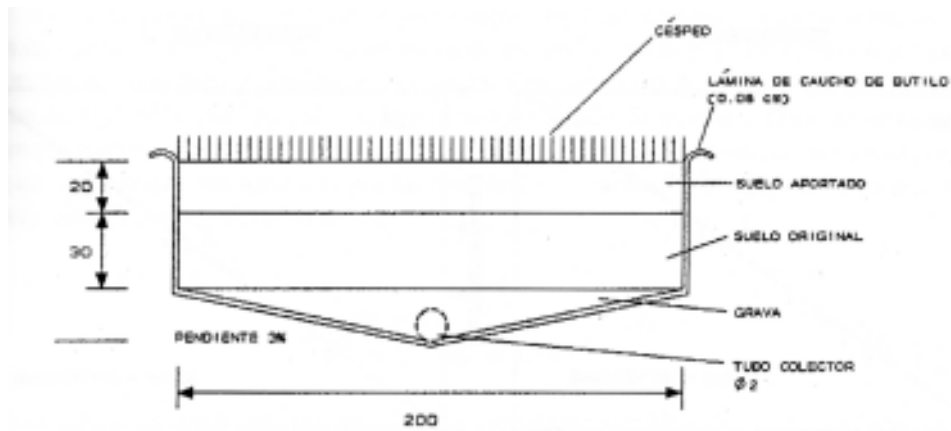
Sección transversal del lisímetro de drenaje (cotas en cm.).
